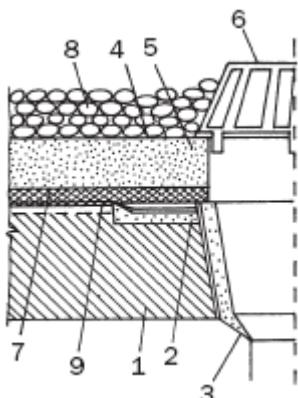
Водосток для инверсионной крыши: 1 – плита перекрытия; 2 – грунтовочный слой; 3 – рулонная гидроизоляция; 4 – экструдированный пенополистирол; 5 – фильтрующий материал; 6 – гравийный дренаж; 7 – металлический фартук; 8 – колпак водосборника; 9 – дополнительная гидроизоляция
